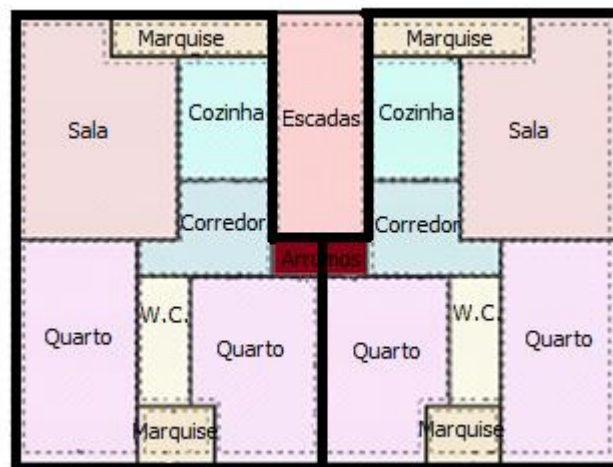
Planta tipo de dois apartamentos do edifício
